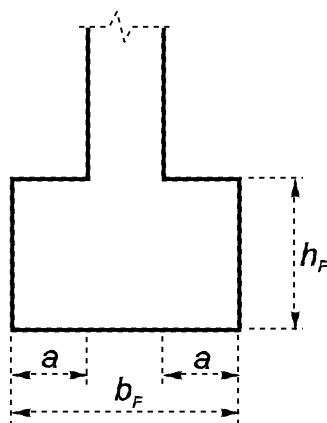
Неармированные столбчатые фундаменты; обозначения
